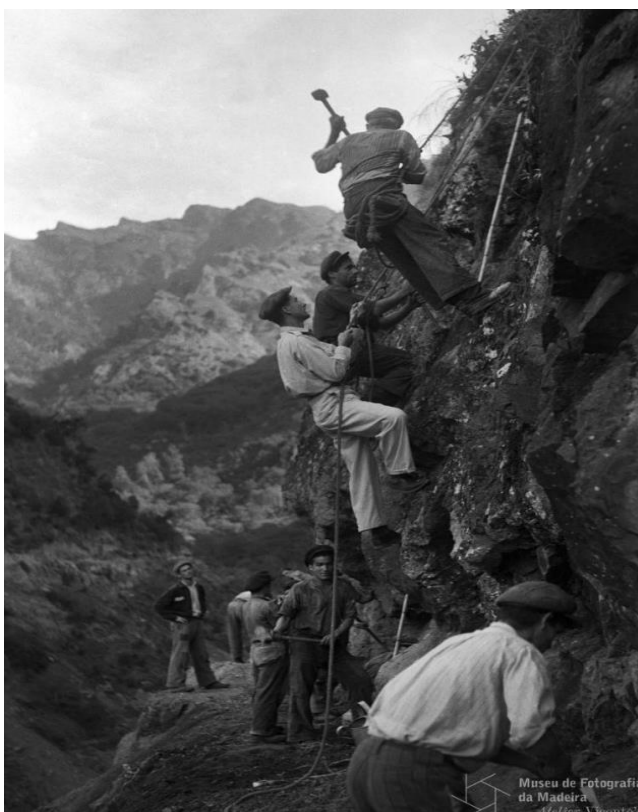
Construção da Levada do Norte, entre 1947 e 1952/ ABM. Fonte: <https://encr.pw/arquivoabm>
